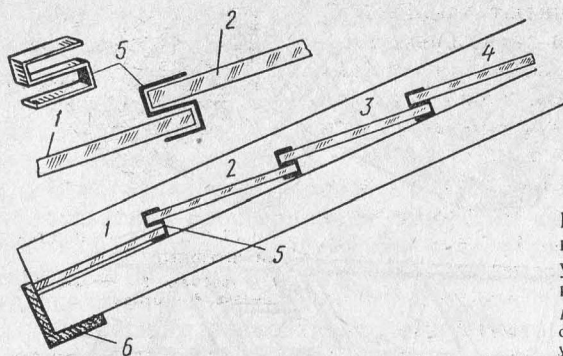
Закрепление стекла и его укладка на крышах и фонарях:
